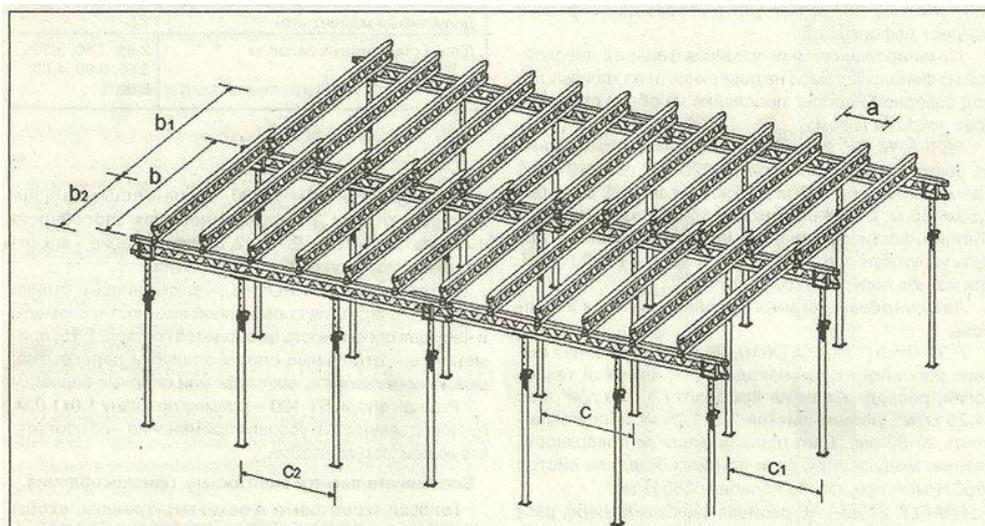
схема элементов балочной опалубки перекрытий:
